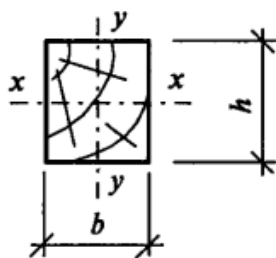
Сечение деревянной колонны — к примеру 5.4
